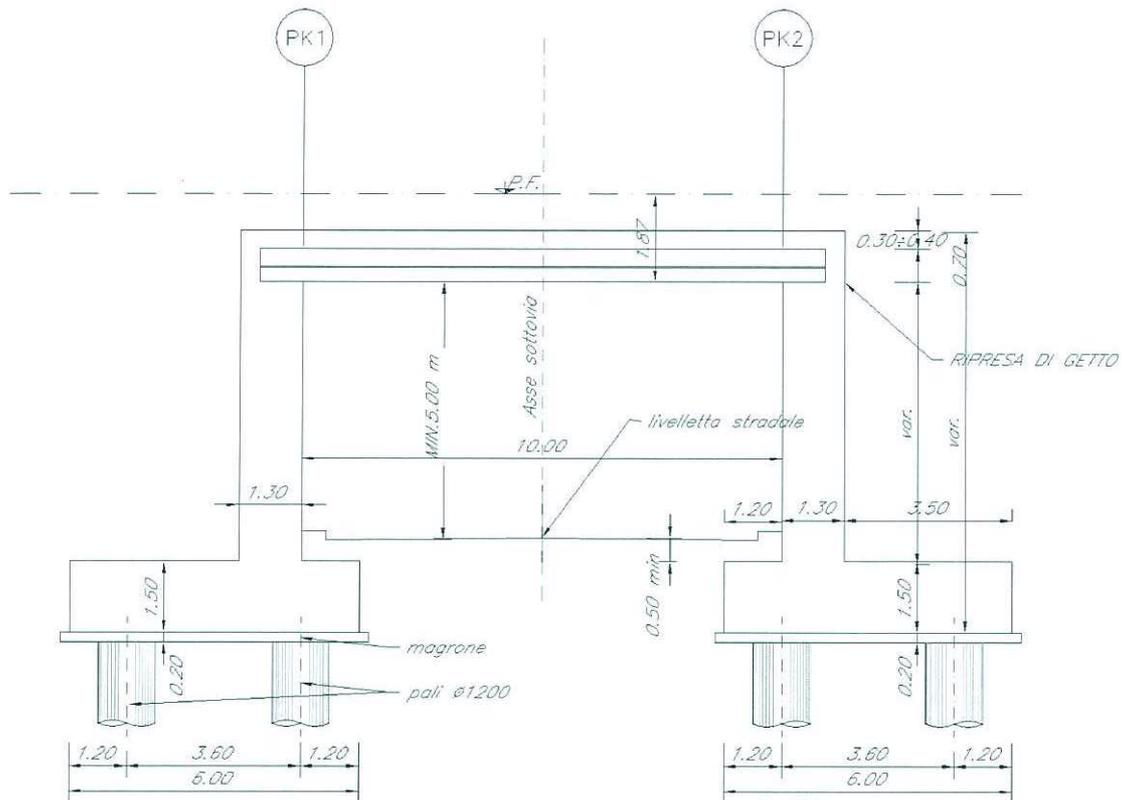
Prospetto in corrispondenza di attraversamento stradale.
